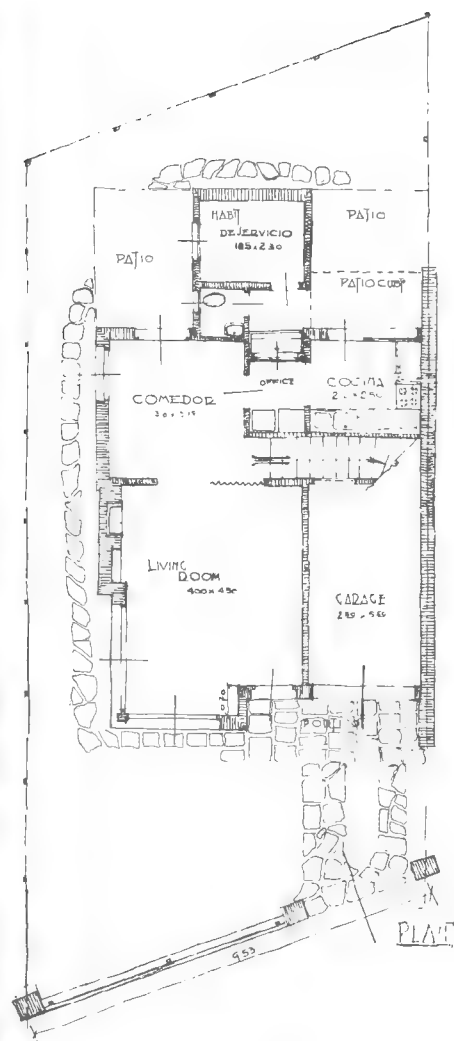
La casa levantada en el lote designado con la letra D. — Al costado las plantas correspondientes
